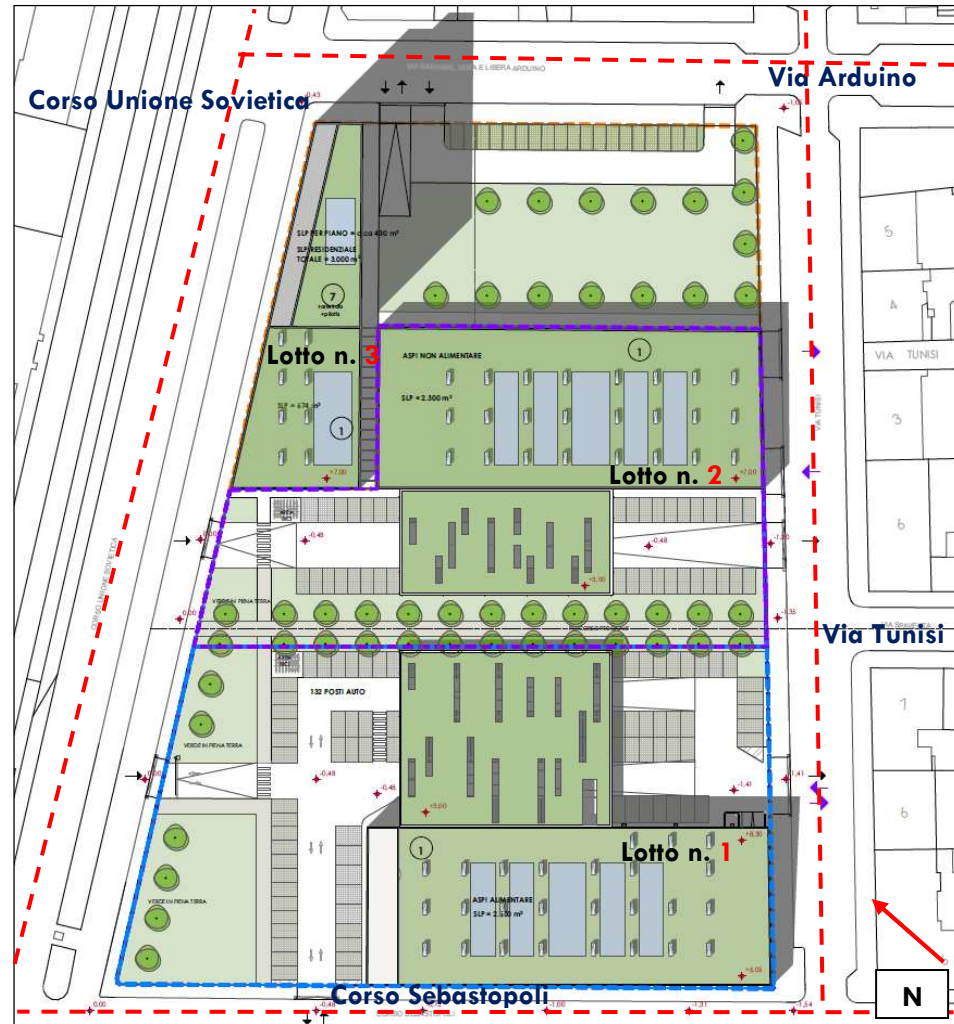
Estratto progetto architettonico: planimetria P.E.C.
